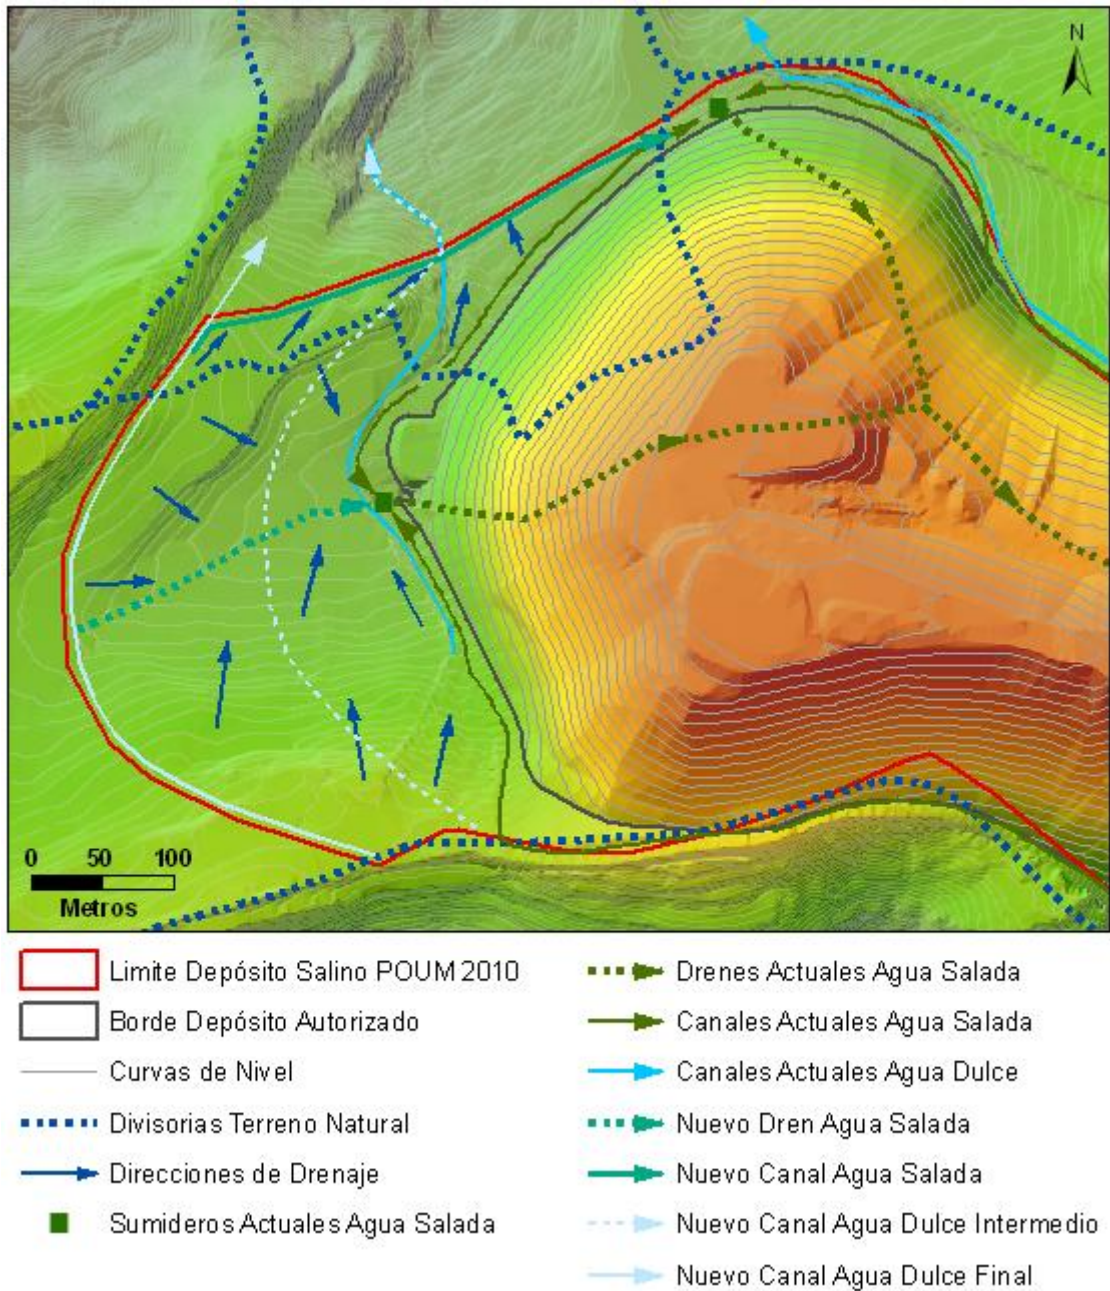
Direcciones y elementos de drenaje a instalar en la zona de ampliación.
